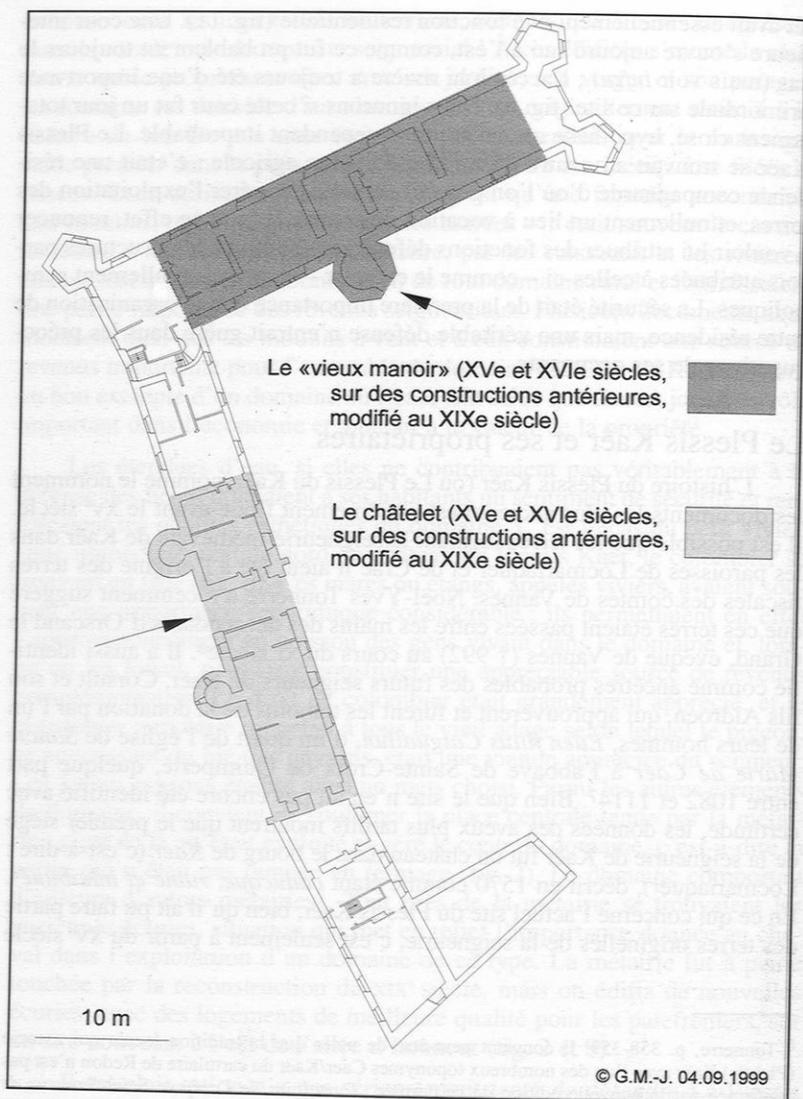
Plan du Plessis Kaër (rez-de-chaussée)
